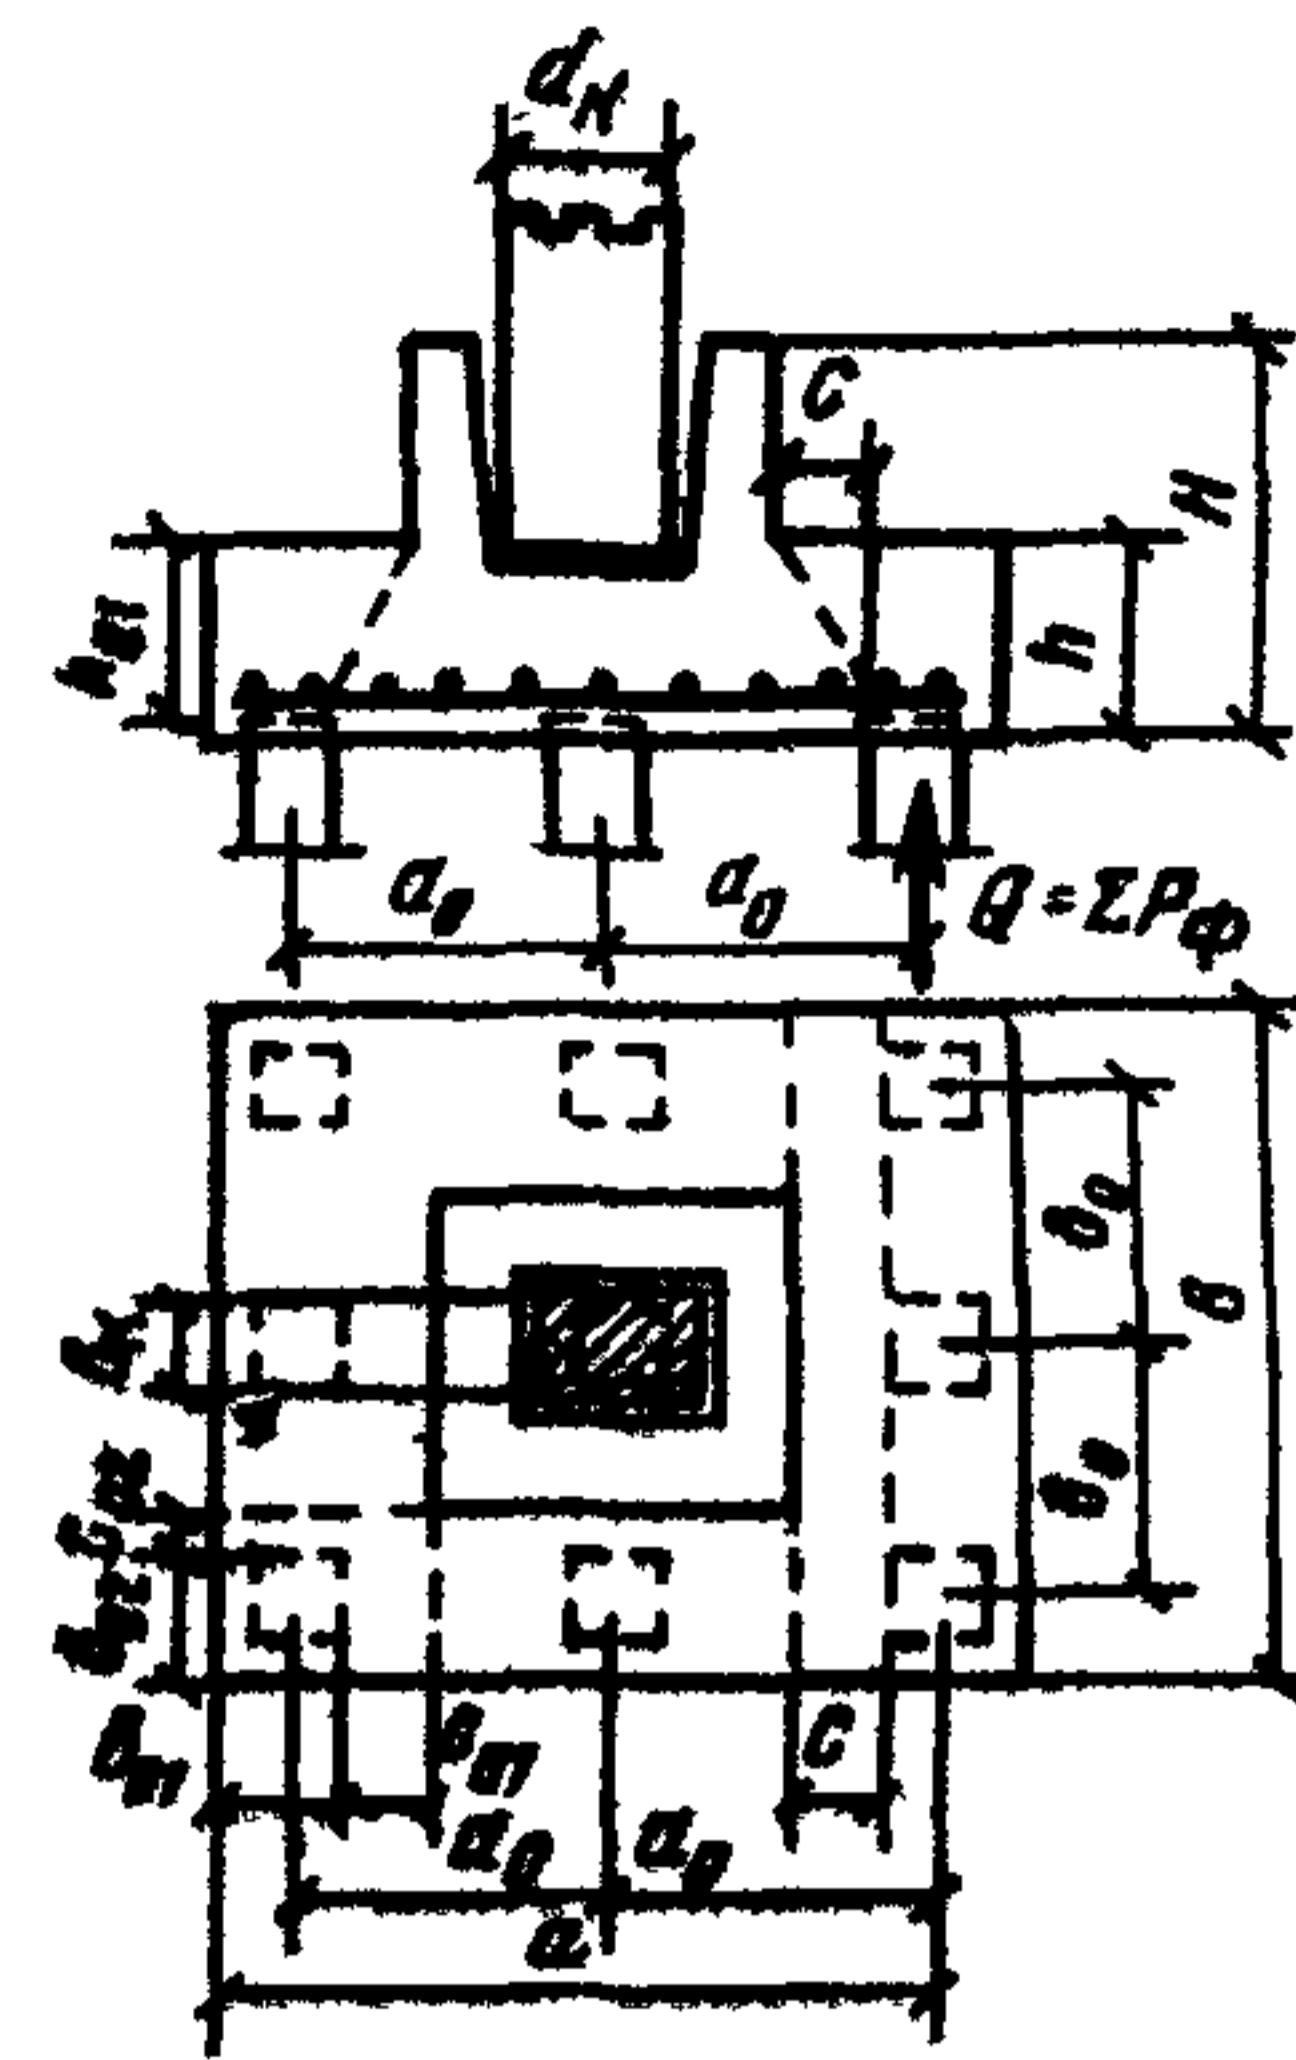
Схема расчета наклонных сечений ростверка на действие поперечной силы
